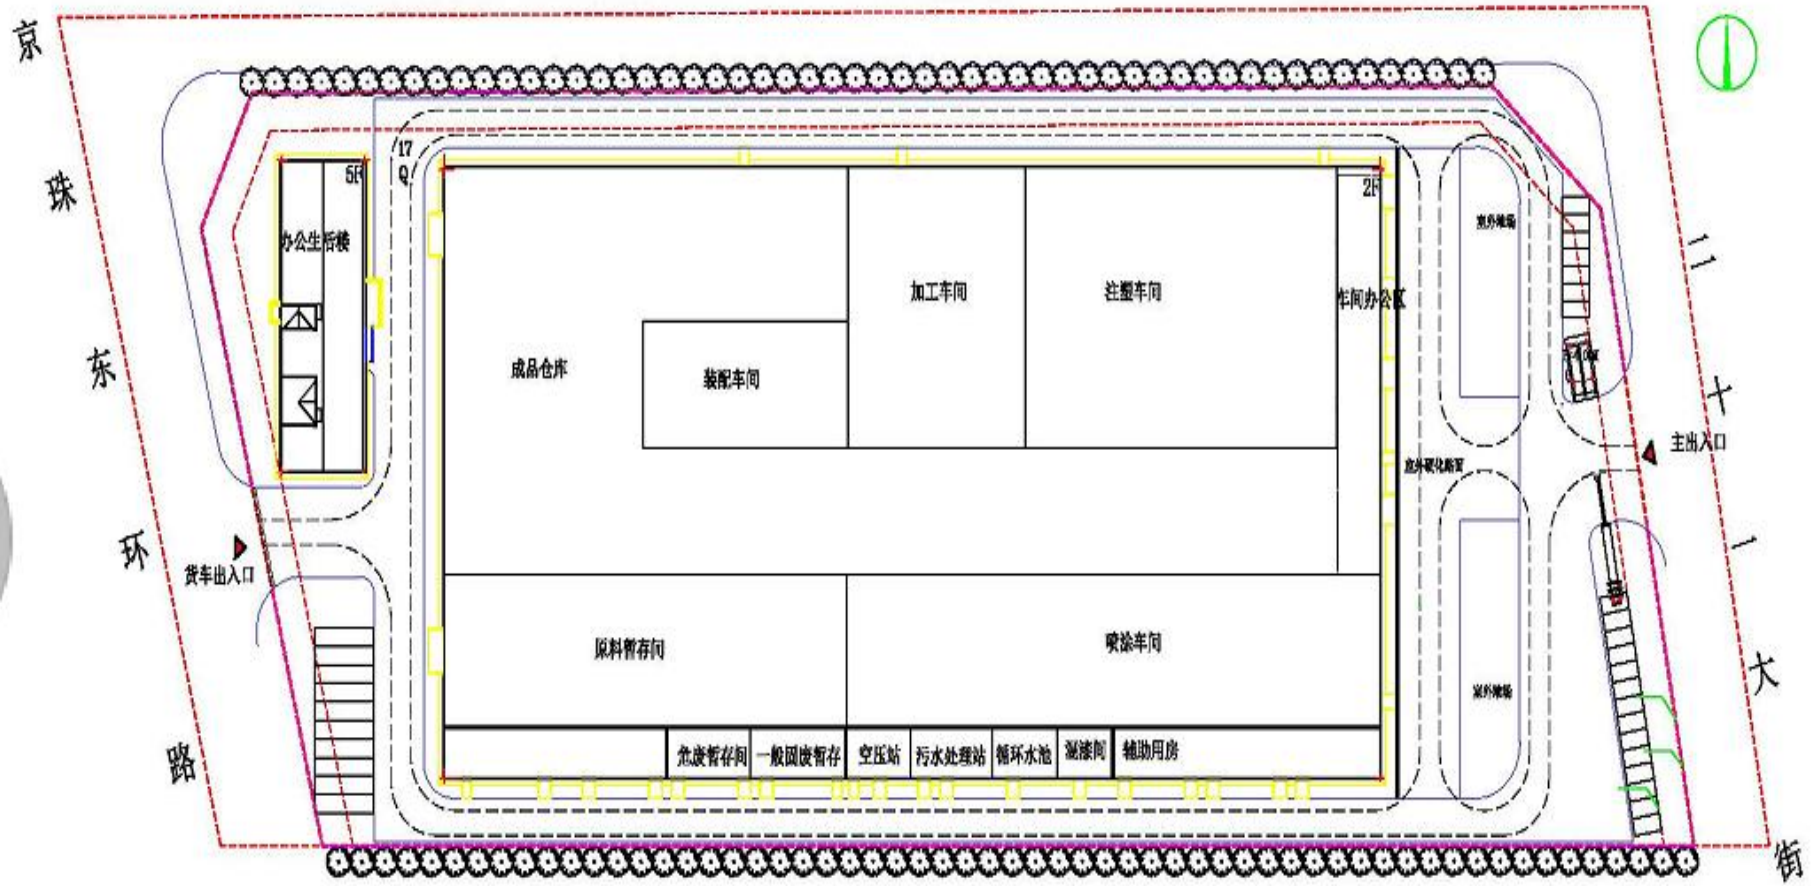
河南俱成汽车零部件有限公司平面布置示意图
